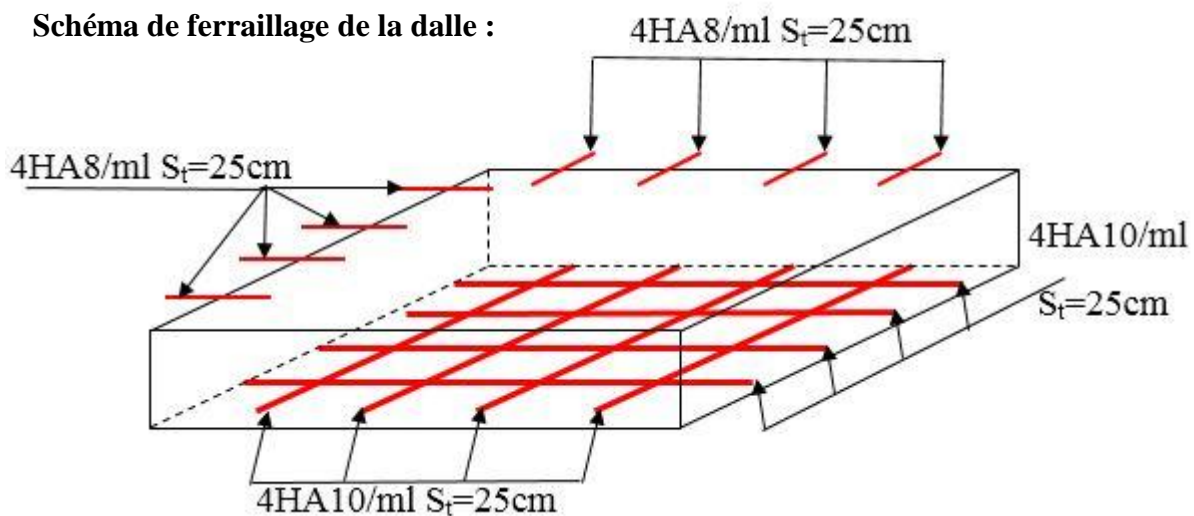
Schéma de ferrailage de la dalle pleine du local machinerie
